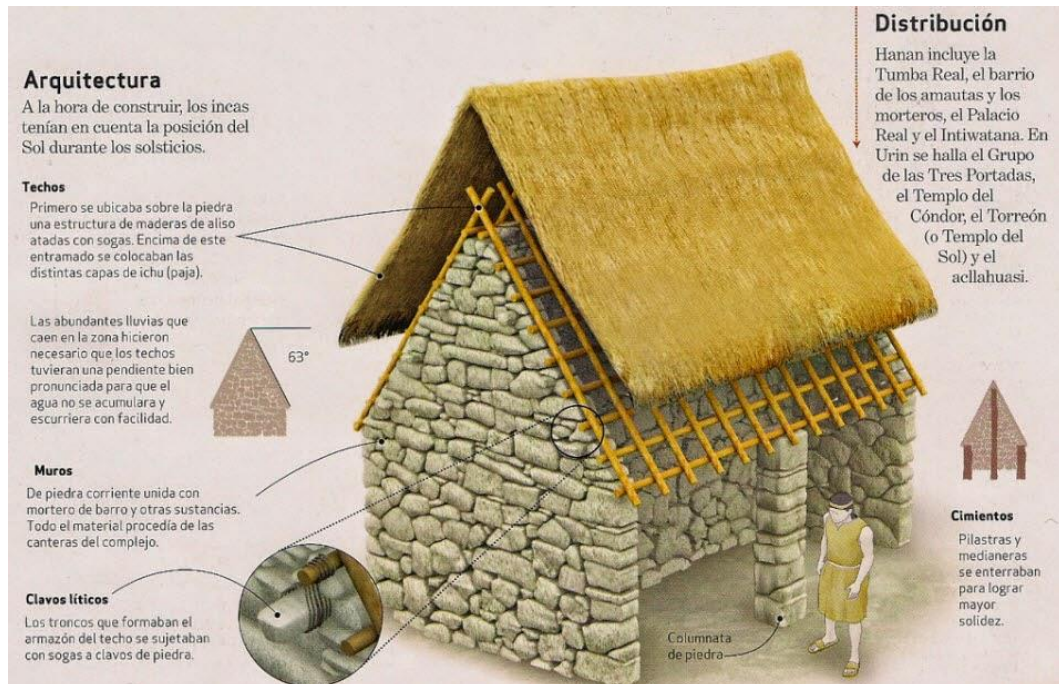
Cubierta típica de las viviendas incas empleando ichu.
